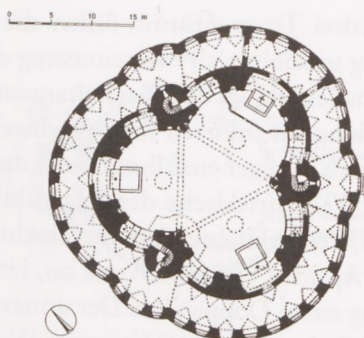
Kappel bei Waldsassen, Wallfahrtskirche
